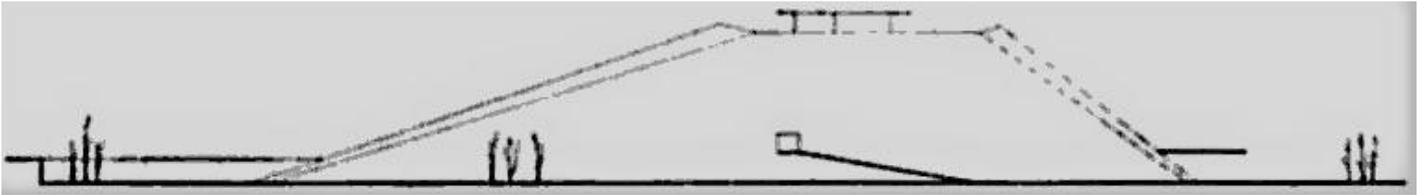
Croqui - Elevação lateral do Teatro Nacional, Niemeyer. Fonte. Revista Projeto.
